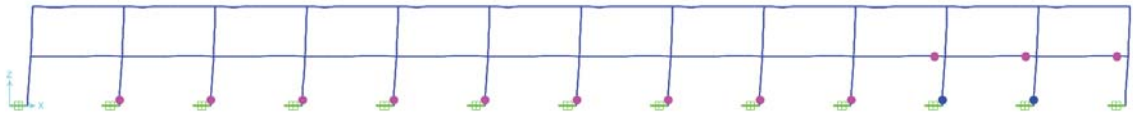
Secciones de columna en estado de Ocupación Inmediata – Aislado
